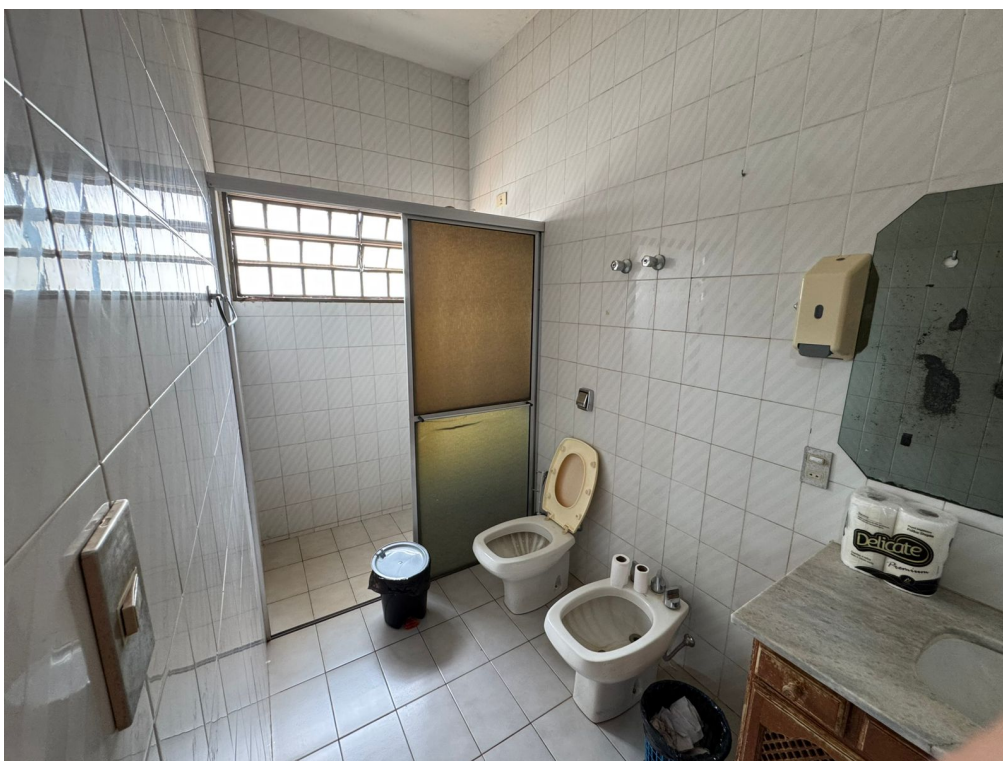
Sanitário da Sala 01 (23/01/2026)
